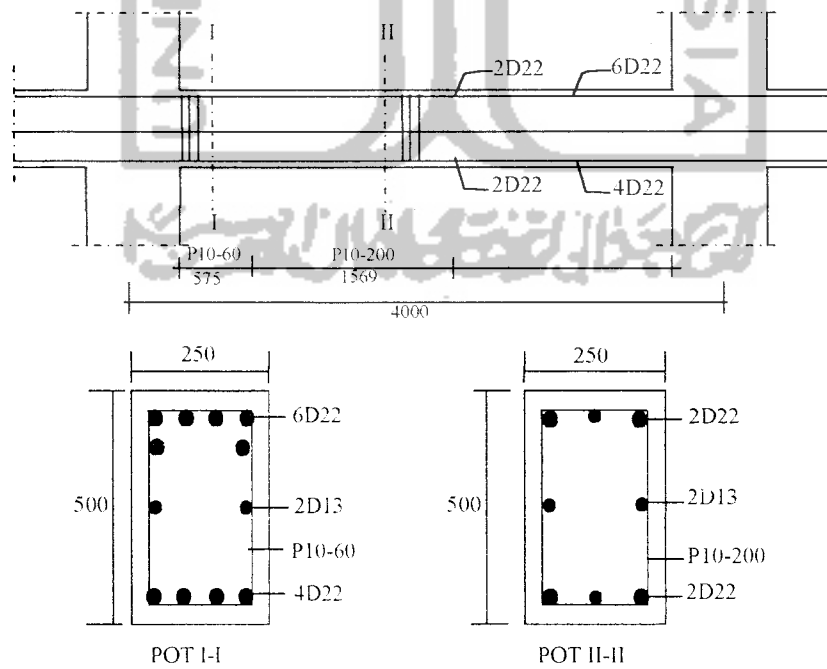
Balok Portal E Bentang 4 m Lantai 4
